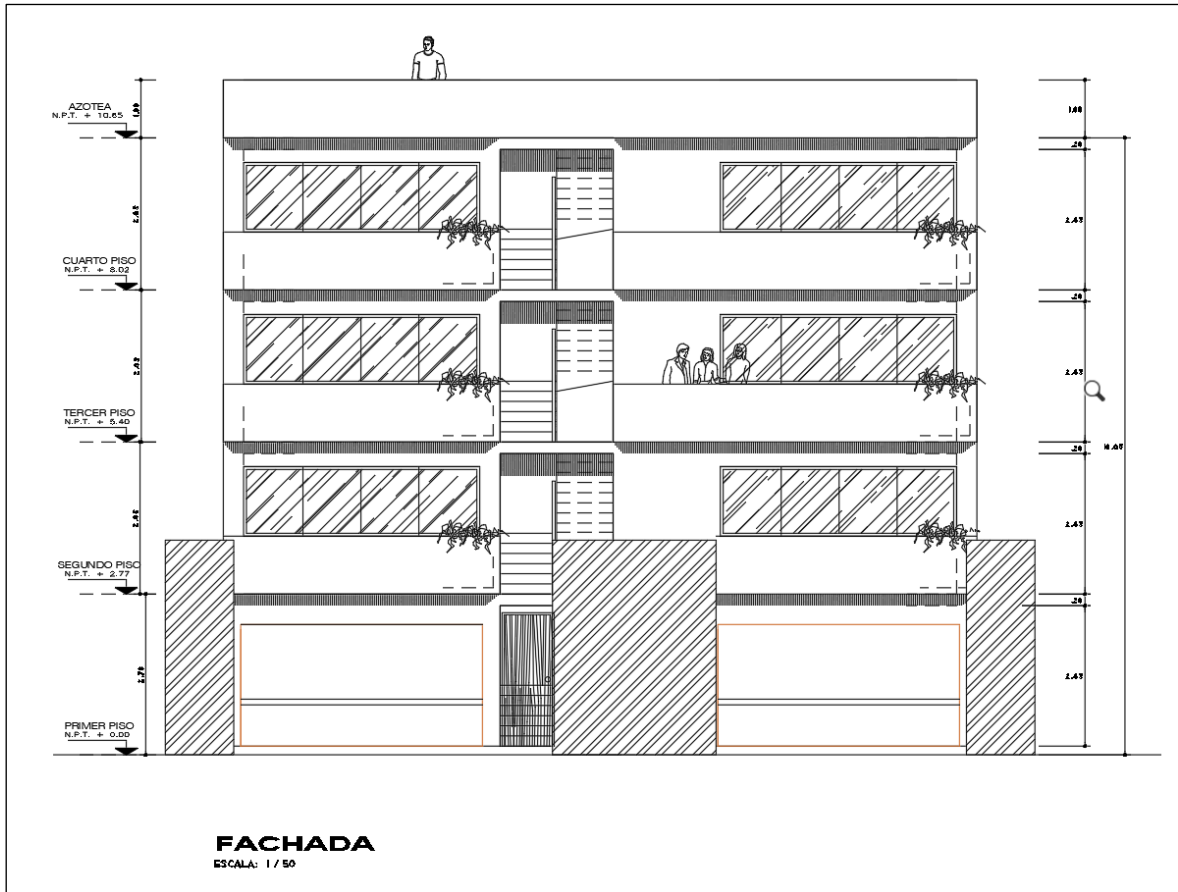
2 Plano de Arquitectura - Corte de Fachada
